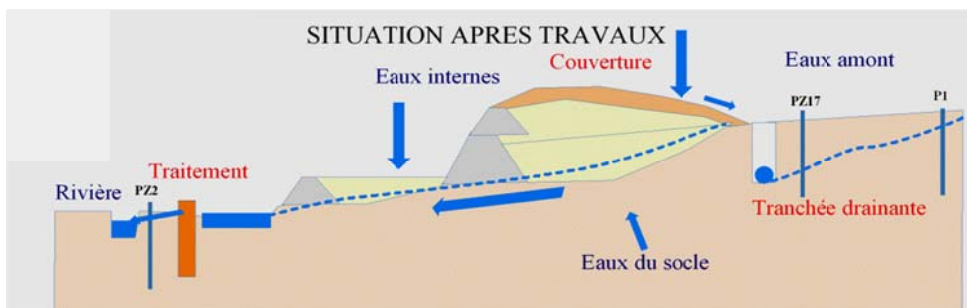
Coupe longitudinale du Nord au Sud du site après les travaux
